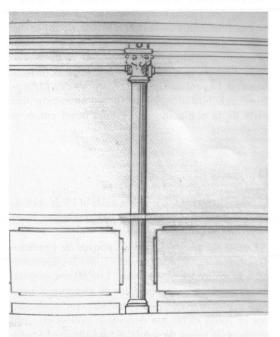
Detalle donde se aprecia la tridimensionalidad del dibujo plano
